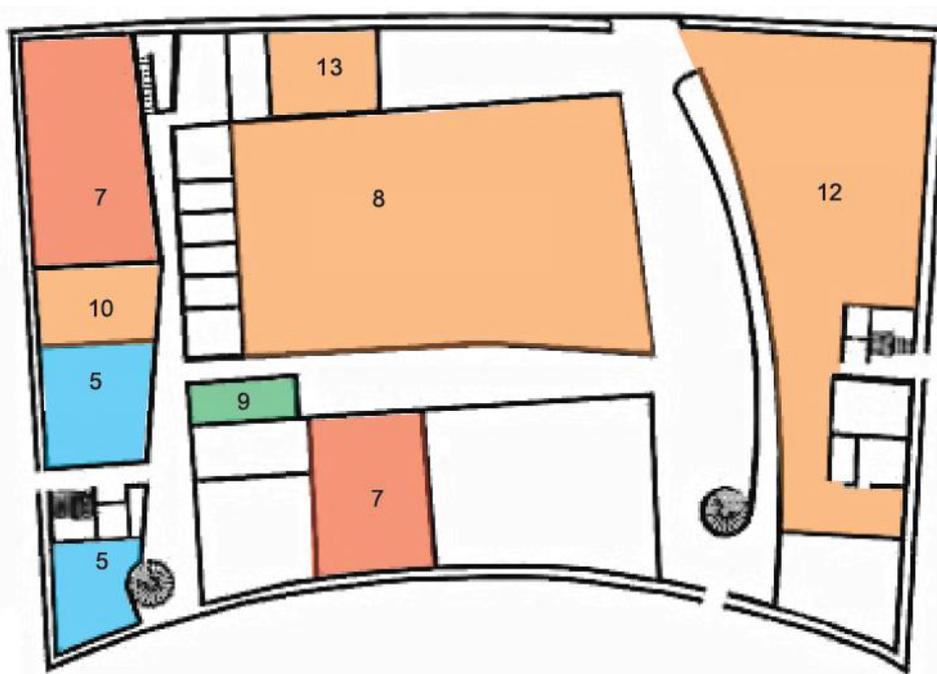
PLANTA PRIMEIRO PAVIMENTO – SEM ESCALA
